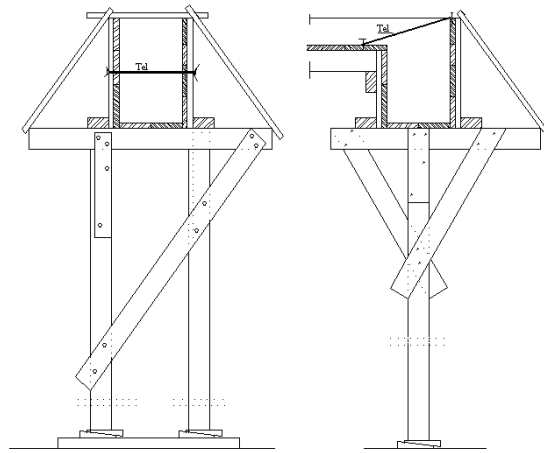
Kolon, kiriş ve döşeme kalıbı ile kiriş taban tahtalarının çakılması
